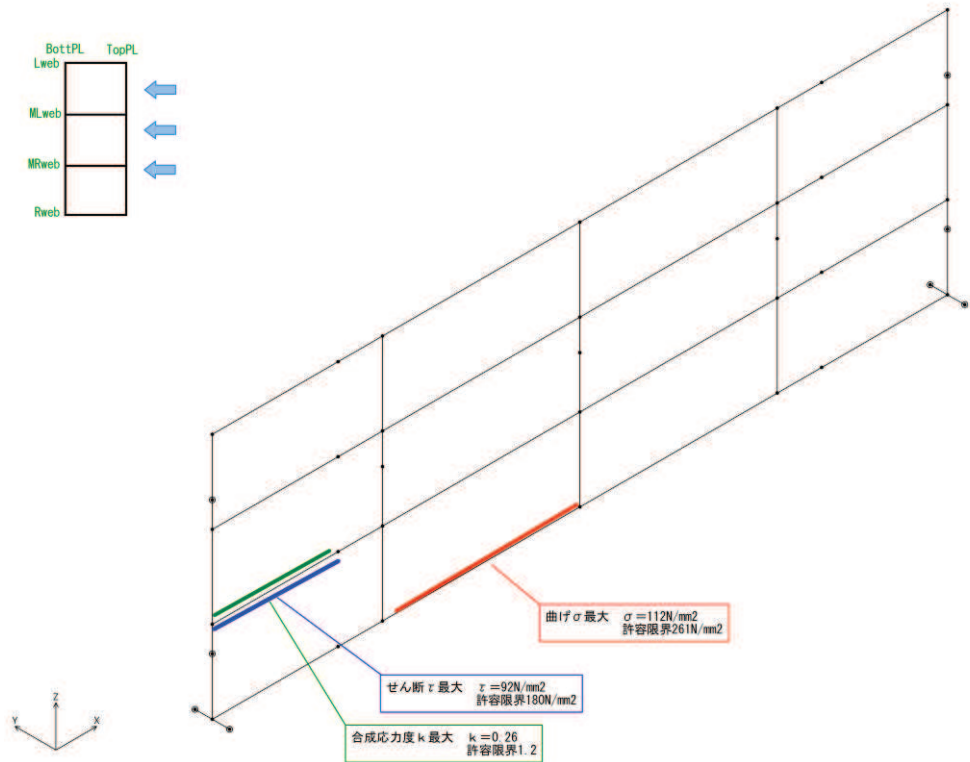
鋼桁の曲げ・軸力系の破壊及びせん断破壊に対する
